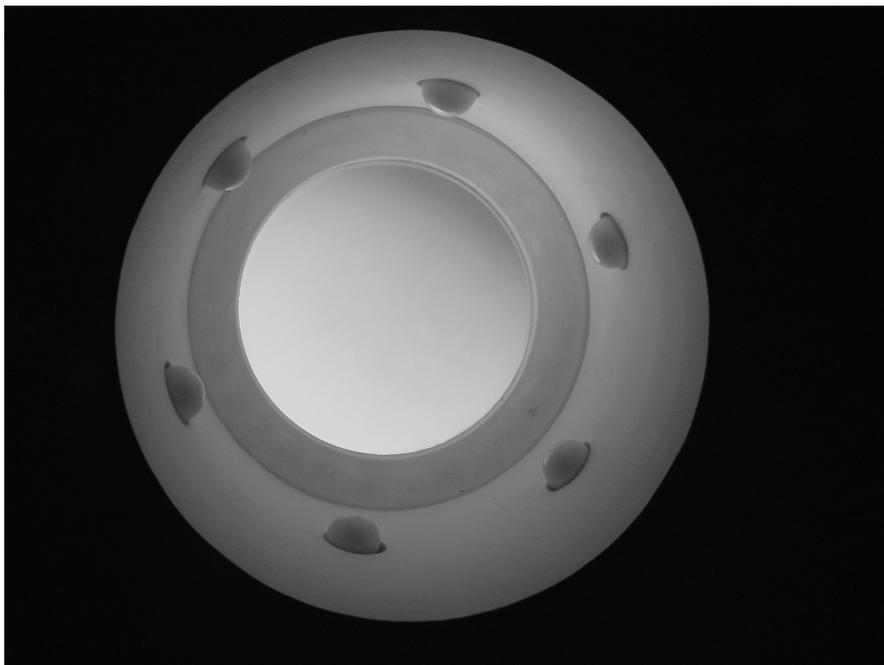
Kongresshalle Gießen: Nahaufnahme einer Deckenöffnung in der ehemaligen Kunsthalle (Foto Budzynski 2009).
